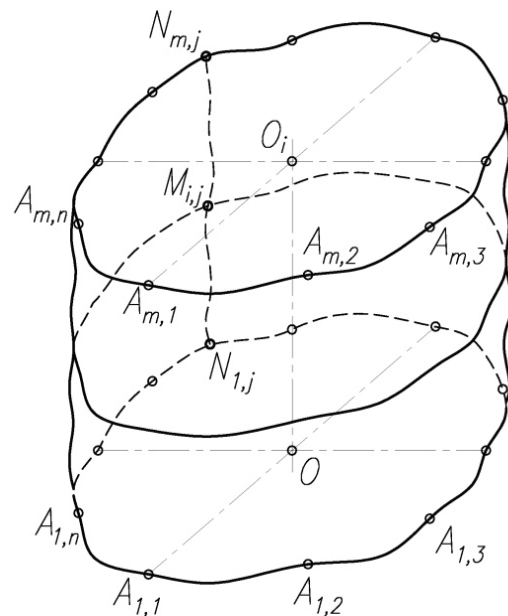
Геометрическая схема стенки резервуара с несовершенствами.
